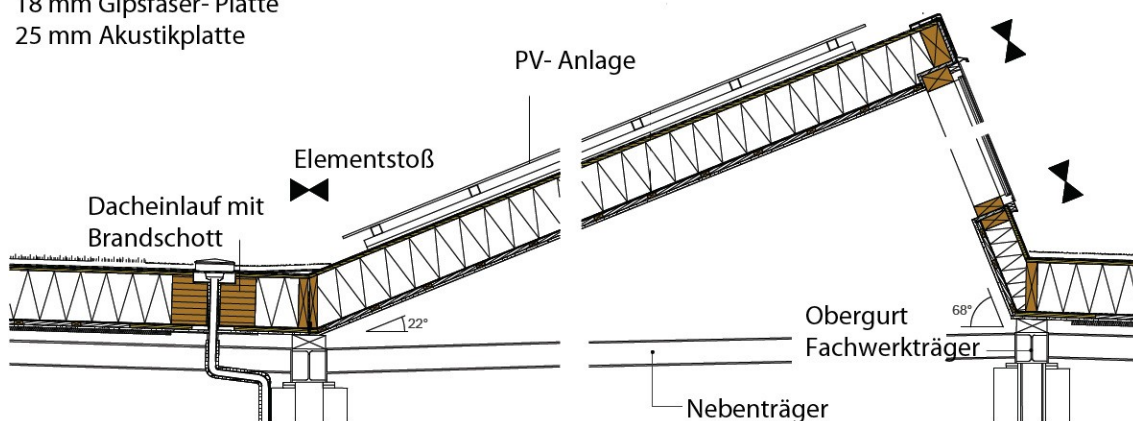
Prinzipieller Dachaufbau (Quelle: HHS, Kassel)
